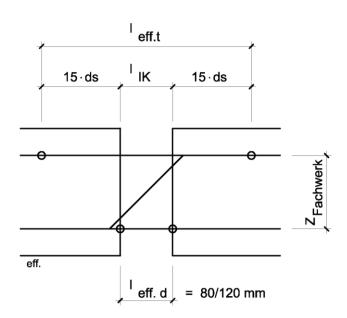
$I_{\text{eff.}}$ für ComBAR®-Stab und Betondrucklager gem. Abschn. 2.1.2
